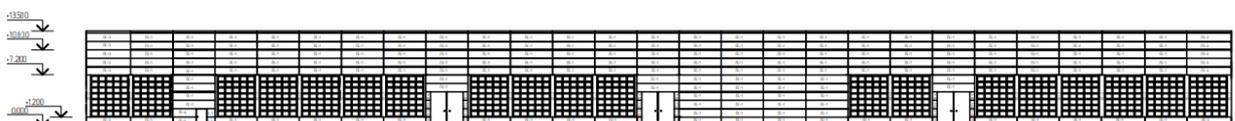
Фасад в осях 1-27 проектируемого здания
